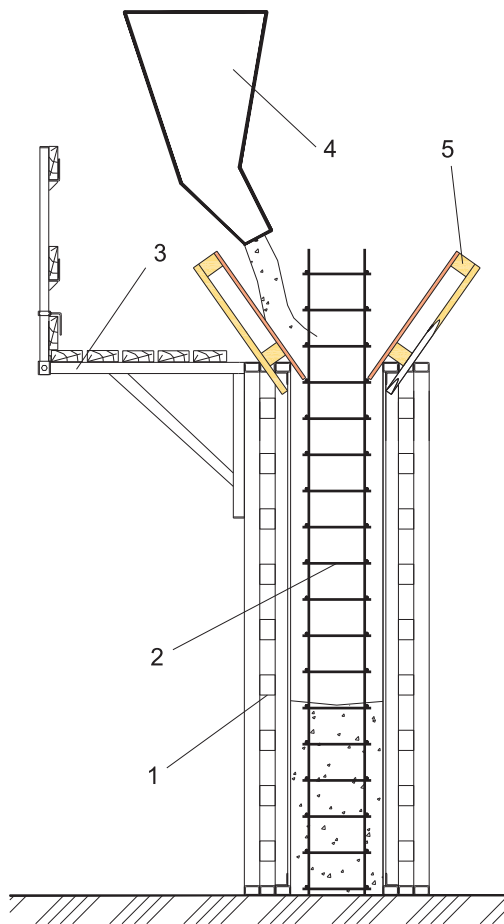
Схема укладки бетонной смеси в опалубку способом «кран-бадья»:
